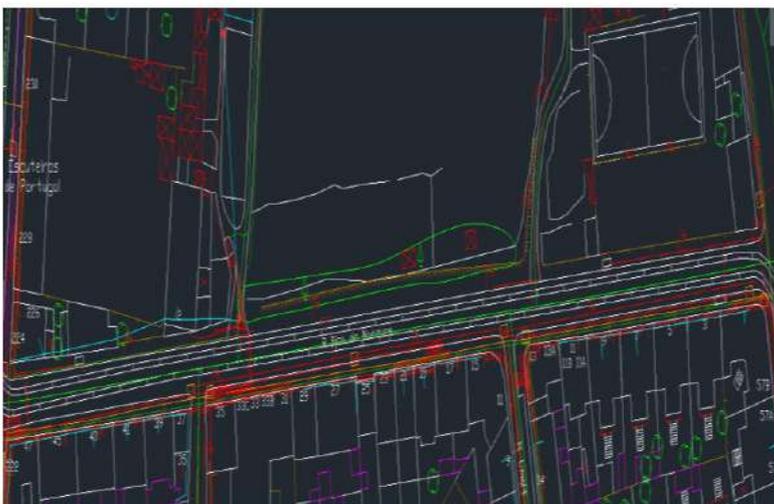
Traçado da rede de energia elétrica de baixa tensão.
